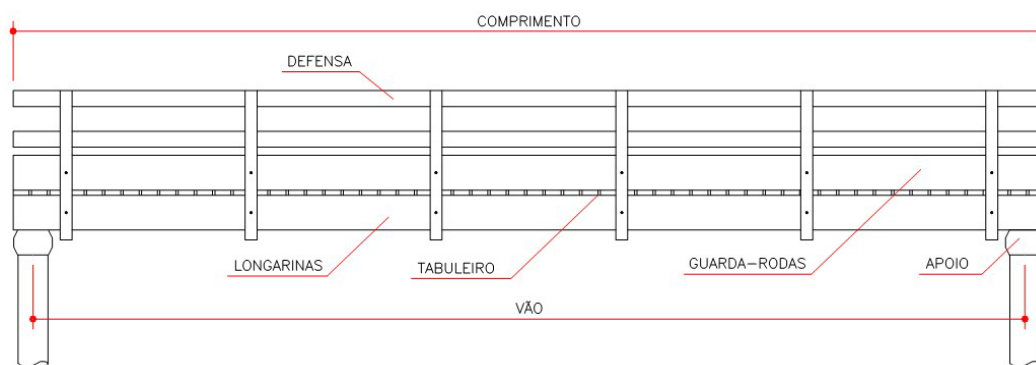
Ponte em vigas roliças de madeira tratada: vista lateral da ponte. Fonte: CALIL et al (2006).
